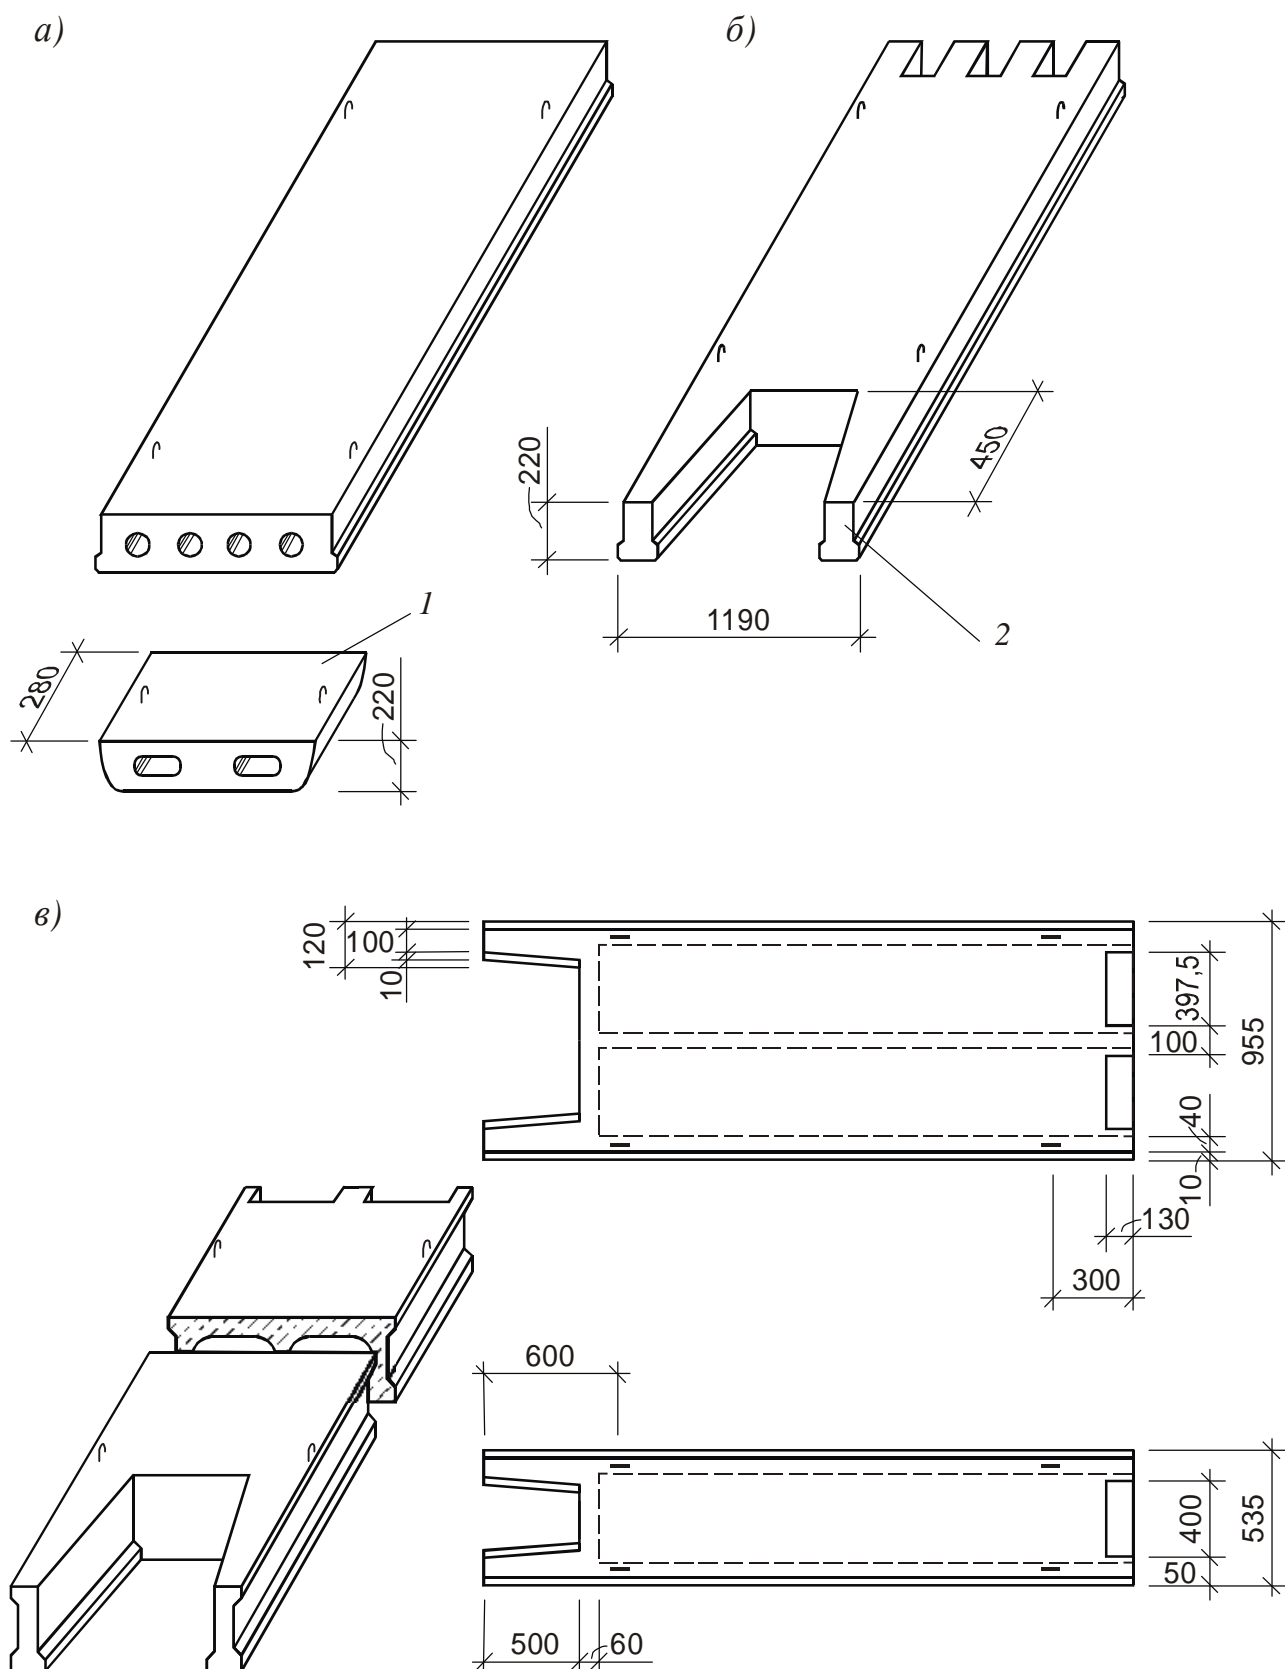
Крупноразмерные железобетонные конструкции перекрытий:
